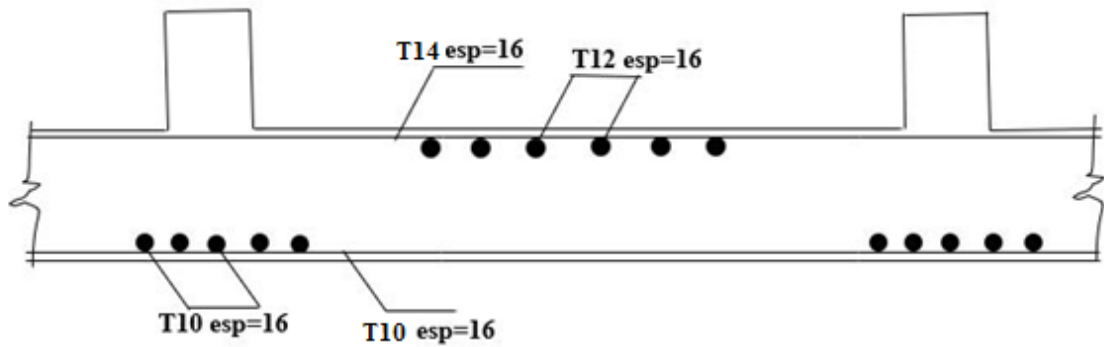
Schéma de ferrailage de la dalle du radier.
